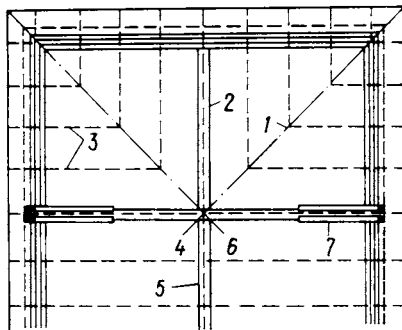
Стропила вальмовой крыши пролетом 6—8 м (поперечный разрез и план)
